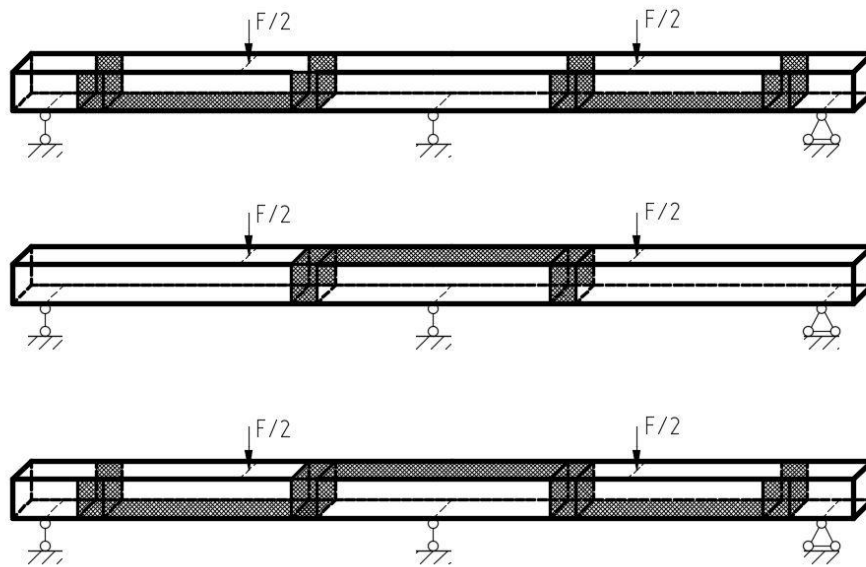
Схемы усиления неразрезных балок, внешне армированных углепластиком под нагрузкой
